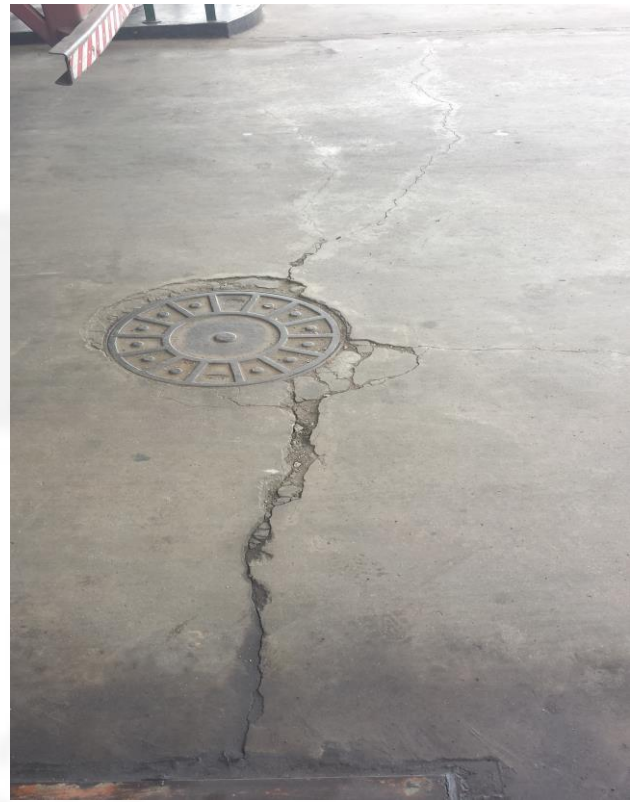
Presença de rachaduras no piso de abastecimento de veículos
